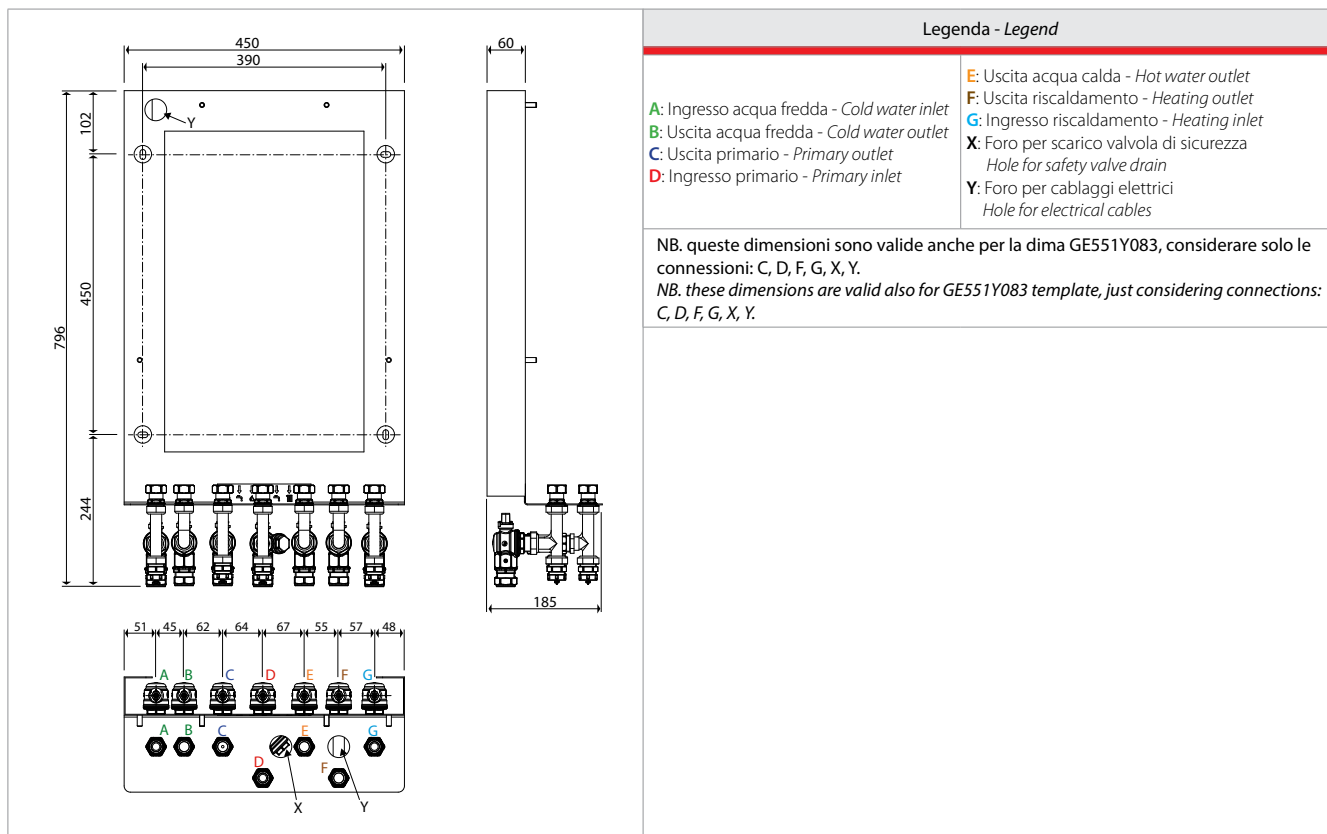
dimensioni in mm (dima GE551Y084) / dimensions in mm (GE551Y084 template)
